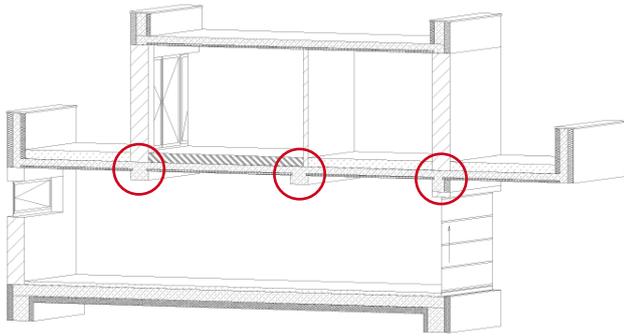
Gewünschte Modellierung für Halbfertigteildecke
